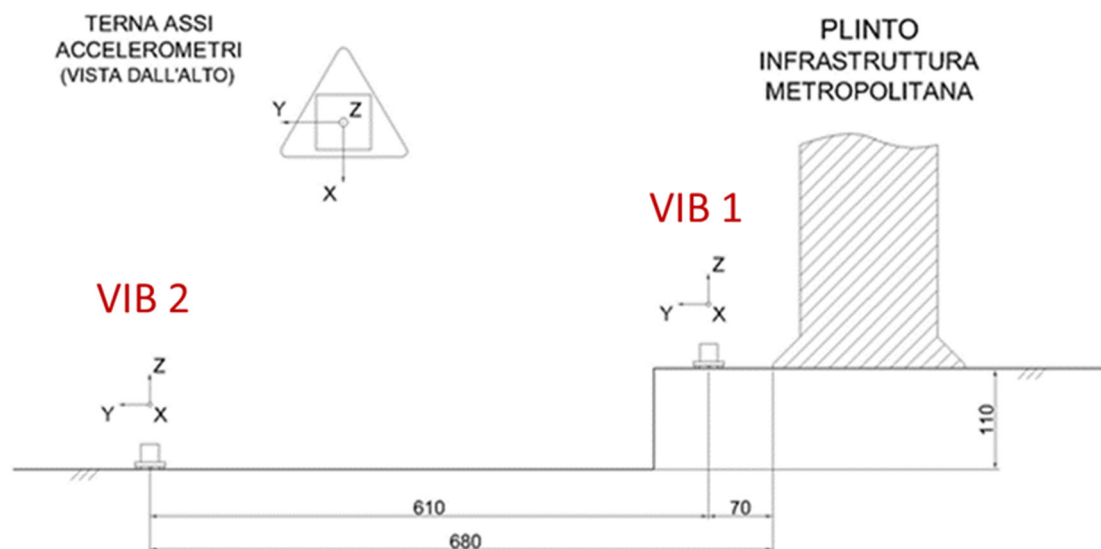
Rilievi in situ: localizzazione dei punti di monitoraggio delle vibrazioni rispetto al piano campagna e piano del ferro
